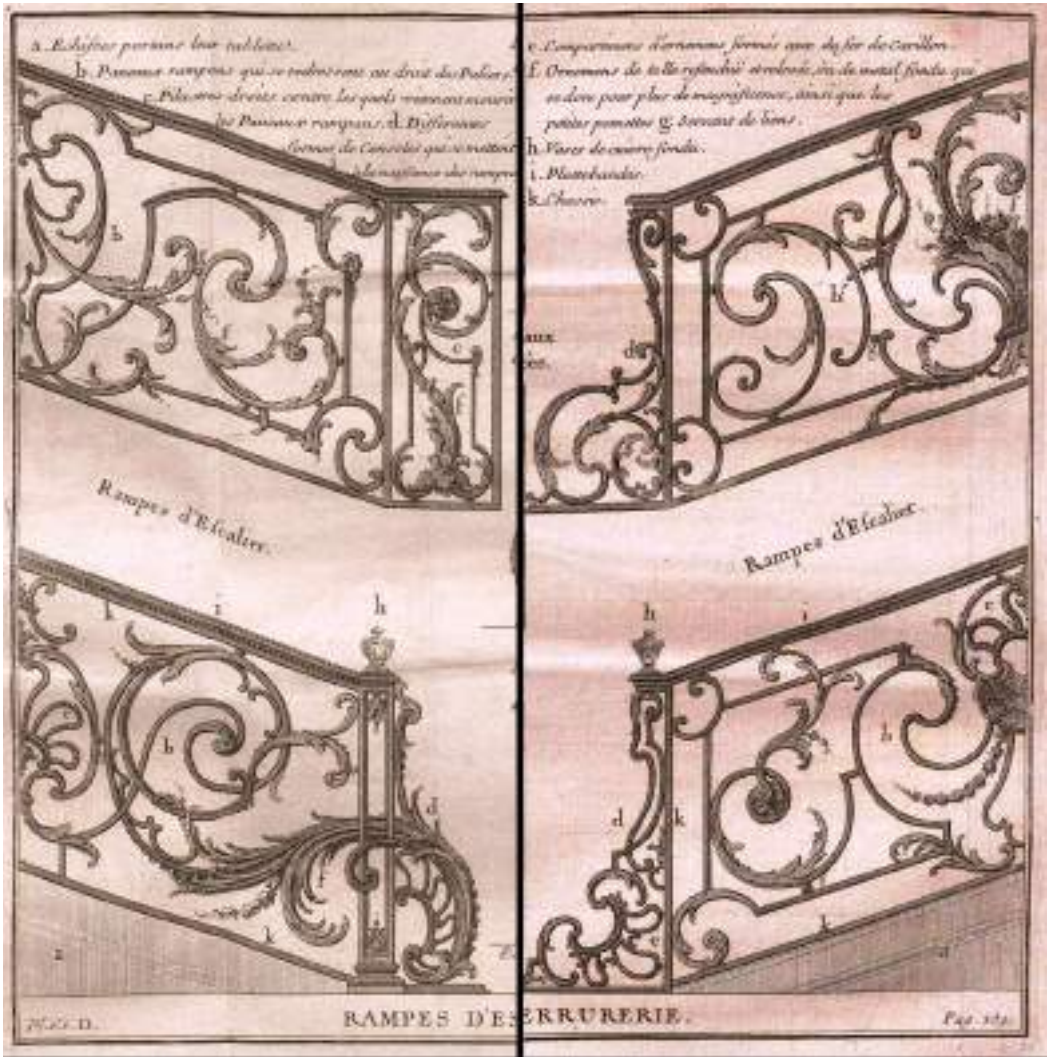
Detalle de la leyenda de la lámina anterior. Cerrajería para barandillas de rampas y escaleras. Tratado D'Aviler de 1750.
